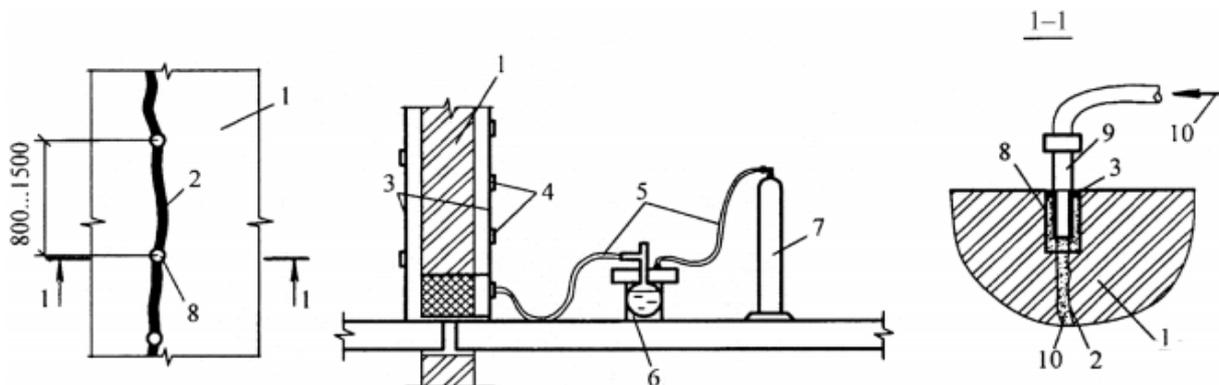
Инъектирование кирпичной кладки с трещинами в конструкции оконного перекрытия:
